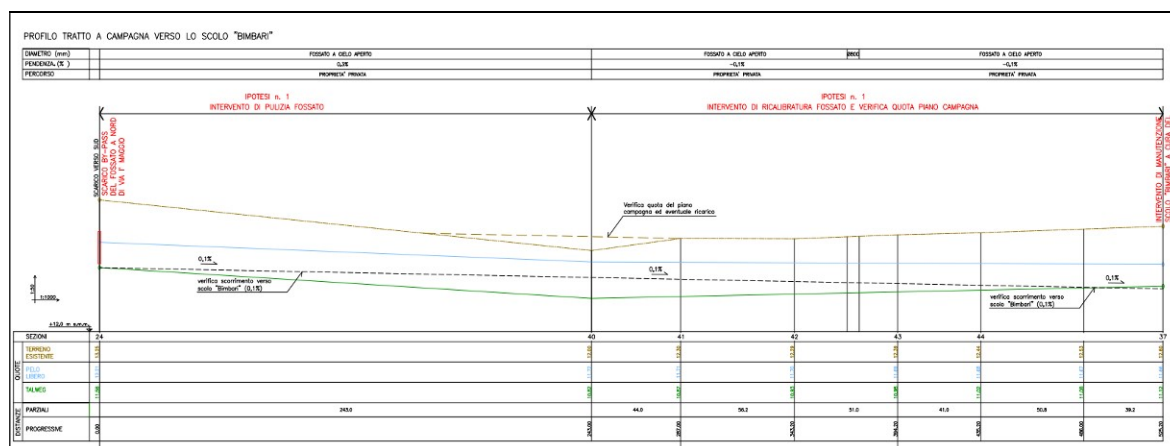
Estratto dall'allegato 3 del Piano degli Interventi comunale – profilo longitudinale
